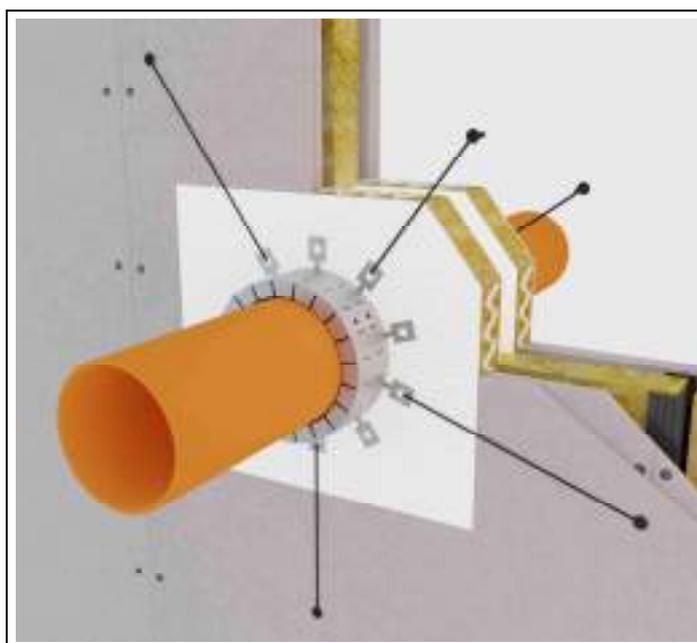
Exemple d'AF Multicollar fixé aux cloisons avec des câbles en acier.
